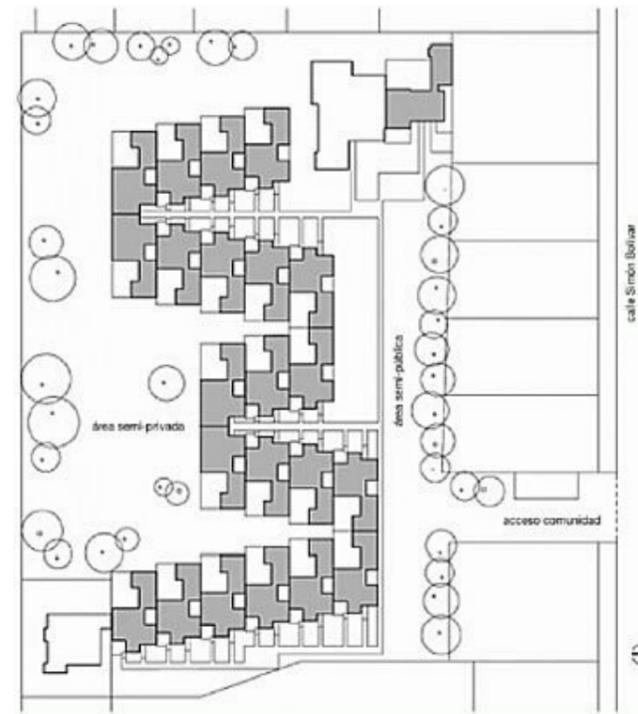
Planta emplazamiento Quinta Michita. Funete: Knust L.
